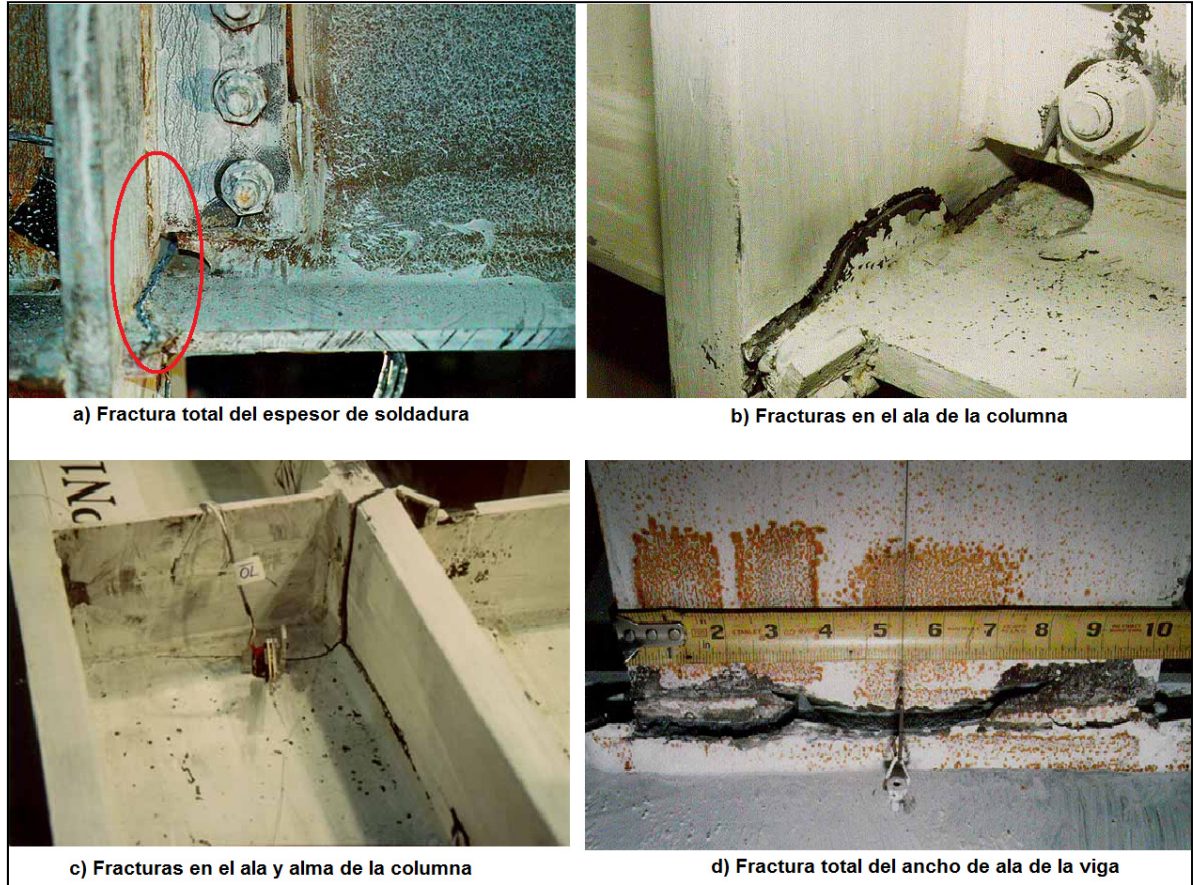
Tipos de fallas en conexiones viga-columna Pre- Northridge.
